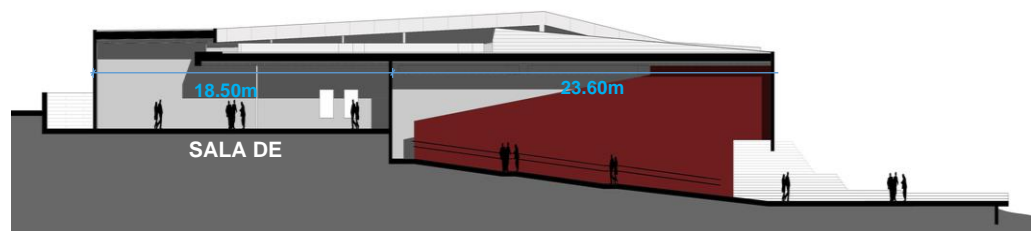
PLANTA GENERAL CON SECCIONES
